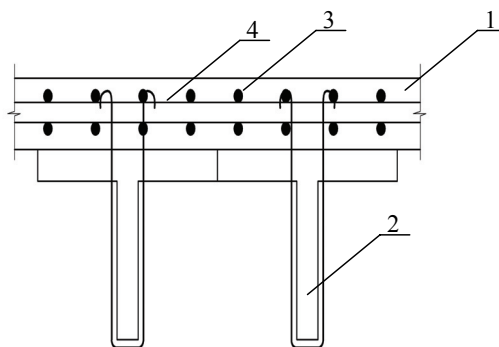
Накладная монолитная железобетонная плита с вертикальными металлическими тяжами: 1 – железобетонная накладная плита; 2 – балка с металлическими тяжами; 3 – стержни рабочей арматуры; 4 – монтажная арматура.
